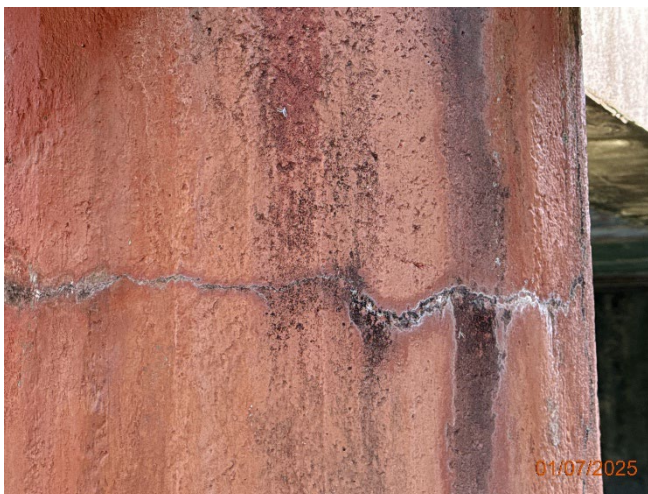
Fissura com percolação de água e eflorescências.
